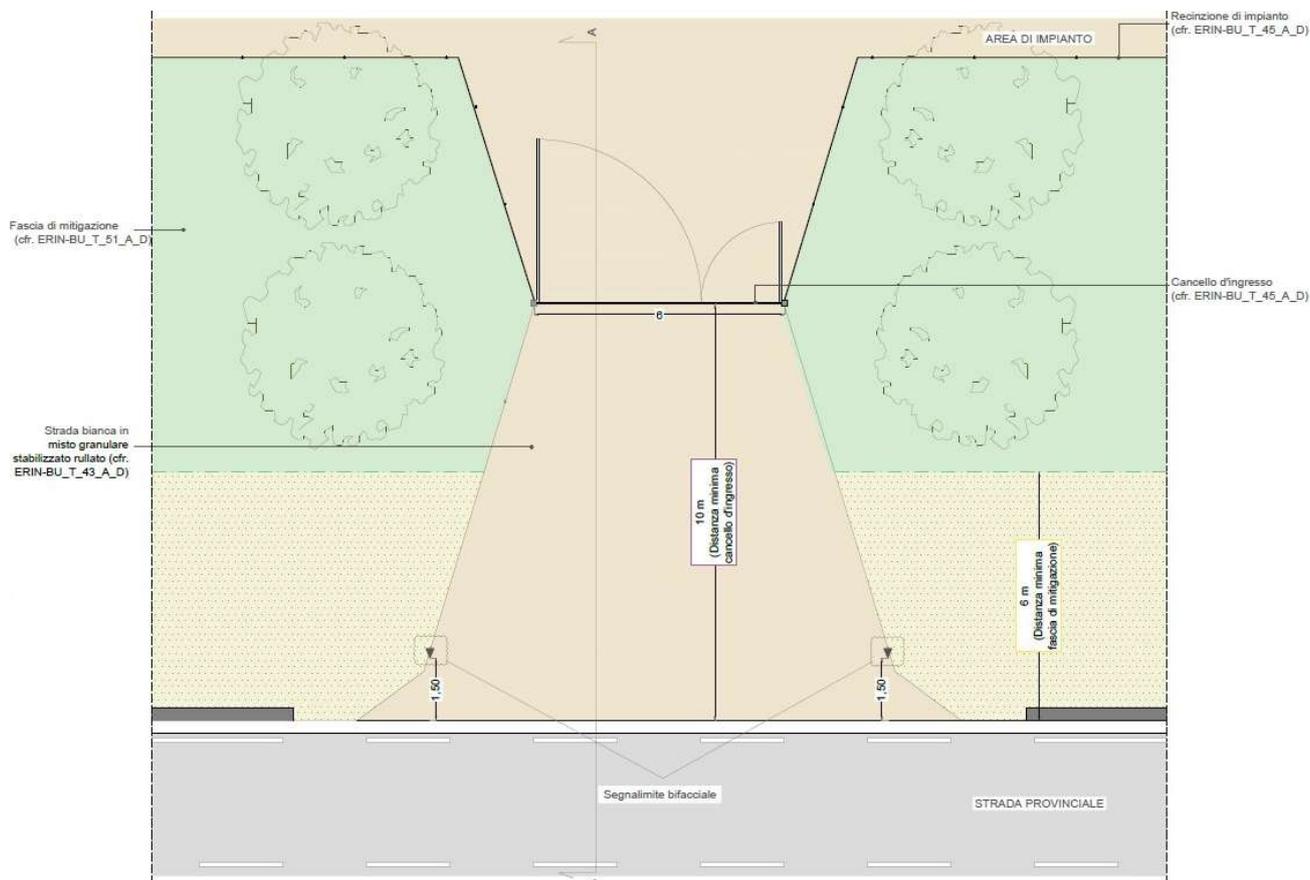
Tipologico planimetria ingresso – tutte le misure in metri
